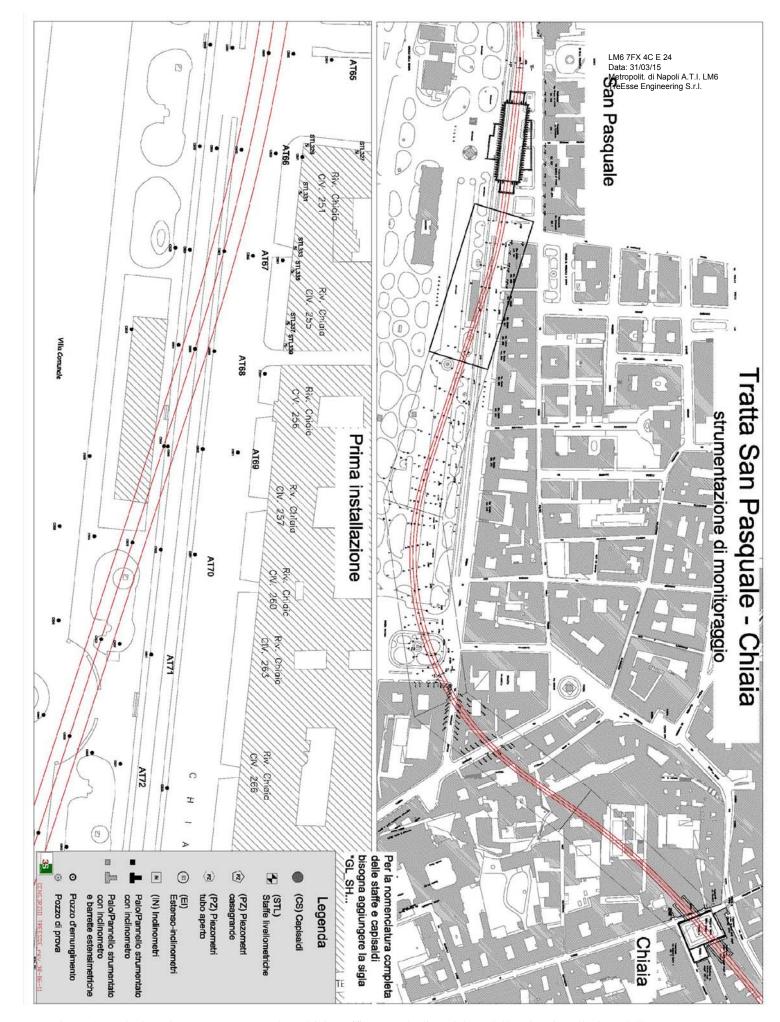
Planimetria tratta San Pasquale - Chiaia, raffigurante la disposizione della prima installazione della strumentazione di monitoraggio.
